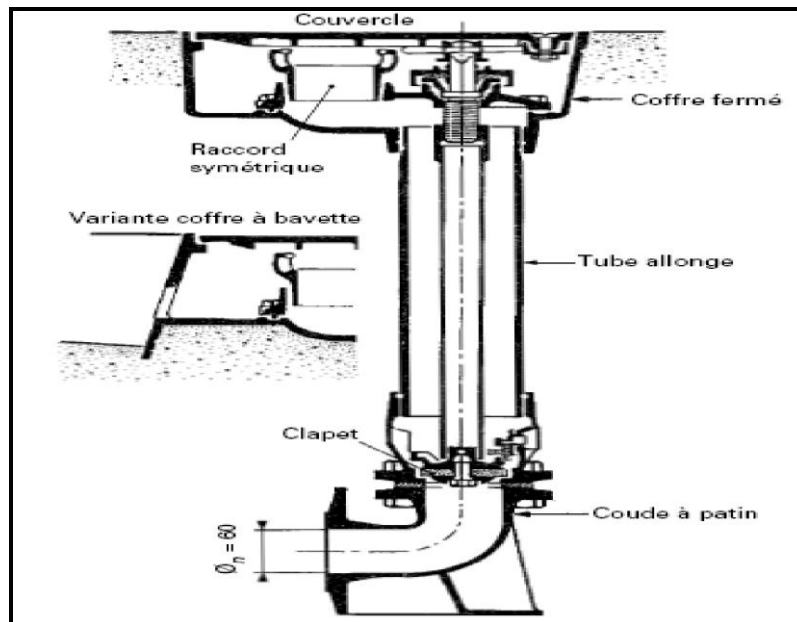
Bouche d'incendie ou de lavage (D'après document Pont-à-Mousson).
